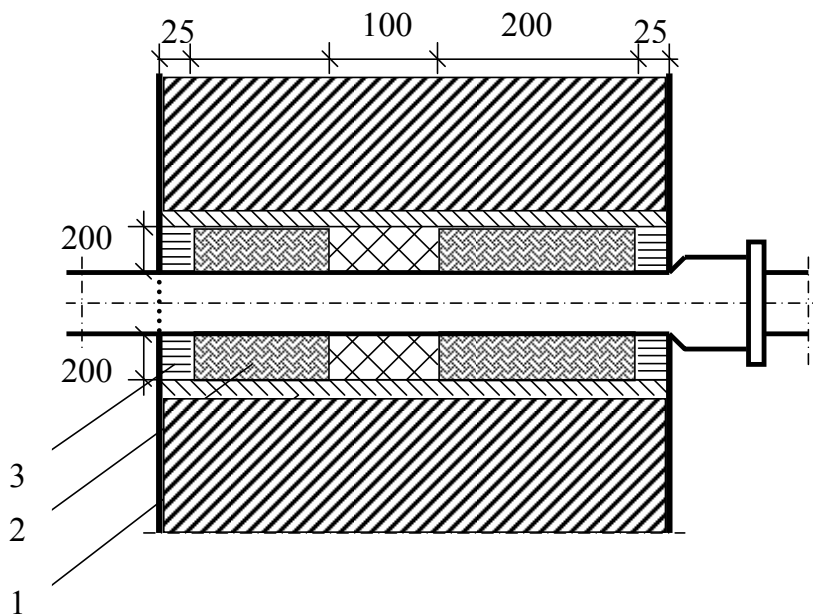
Ввід водопроводу крізь стіну підвалу в сухих ґрунтах:
